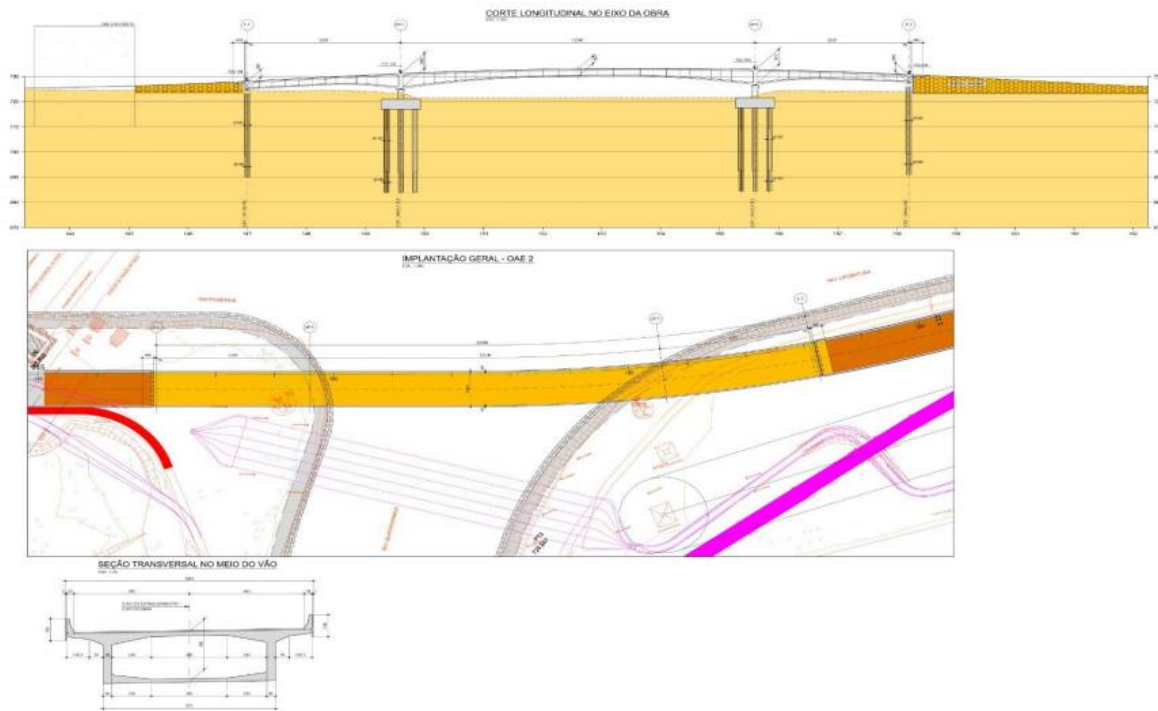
Trecho ponte sobre o Rio Guarapiranga e perfil, objeto de intervenção.
